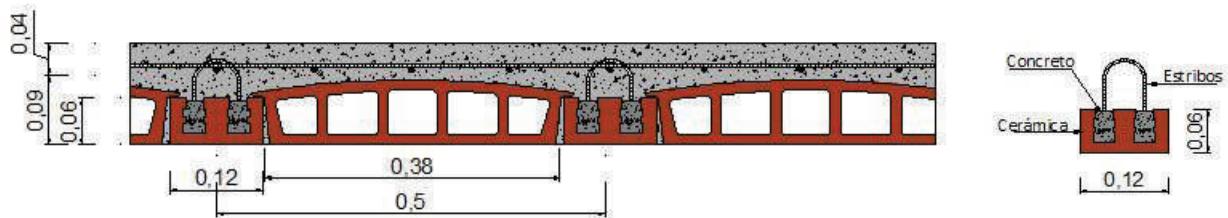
Laje com vigotas Stalton e tavelas de cerâmica. (*-5).
